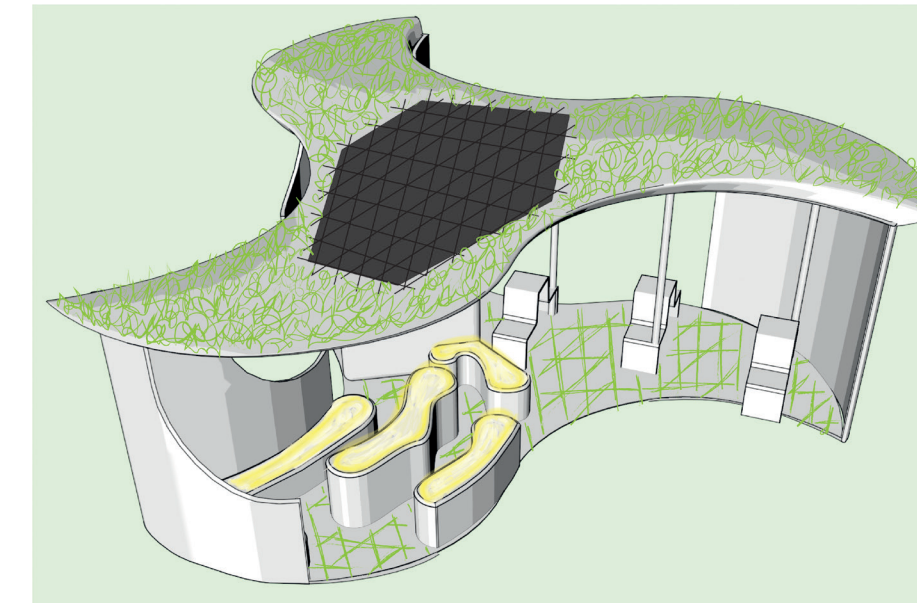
Vista general de Alhambra, con la zona de mesas de luz en primer plano, detrás la zona de con mesas móviles
